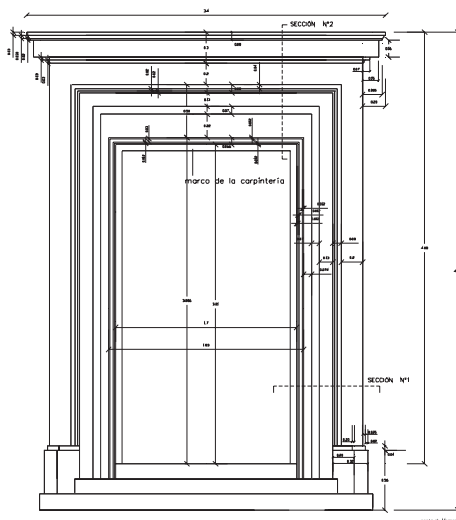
Alzado de la portada de la fachada norte, que se ejecutó mediante terrajado con mortero de cal.
